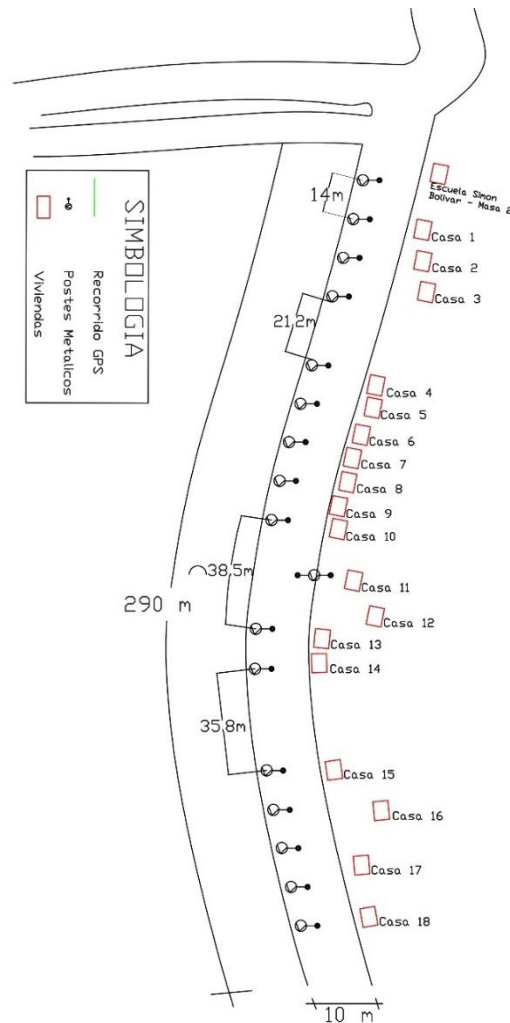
Dimensionamiento del Area Masa 2 – Plano Propuesto
